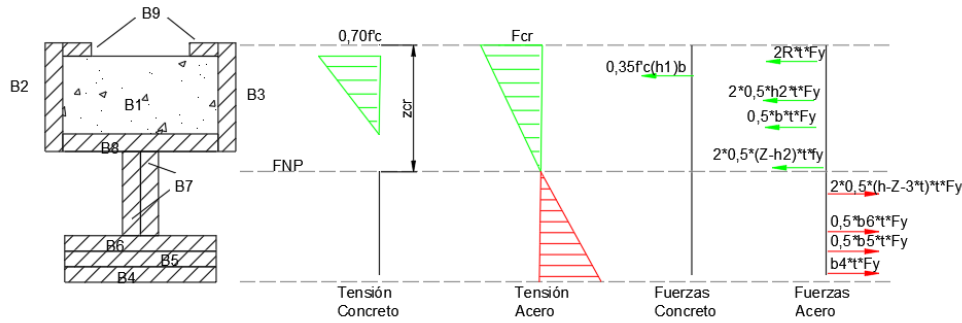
Distribución de tensiones y fuerzas en la Sección N°4 en el rango plástico.
